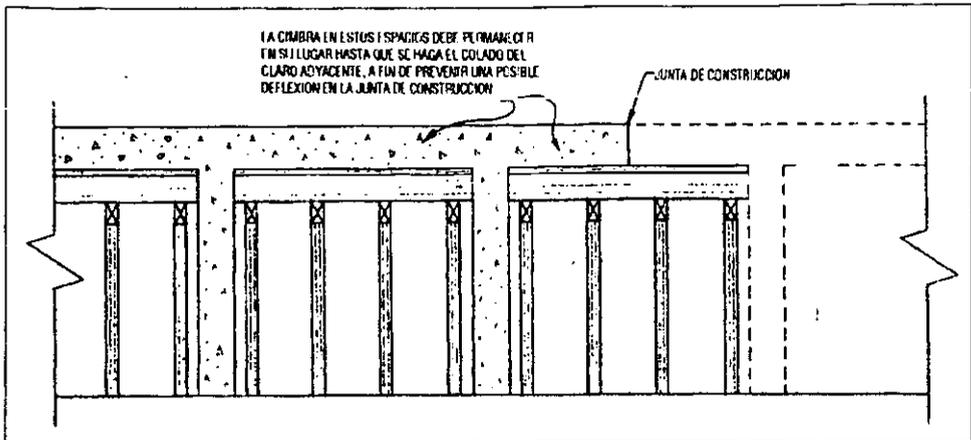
Cimbrado y apuntalamiento en juntas de construcción.
